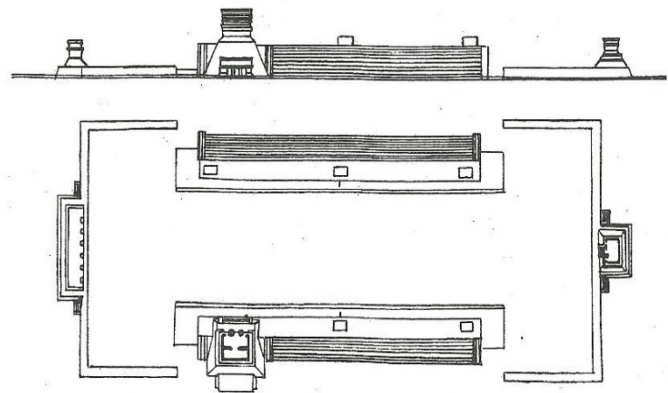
Plano del Juego de Pelota, planta modificada por la construcción de los Templos del Norte, del Sur y de los Tigres
